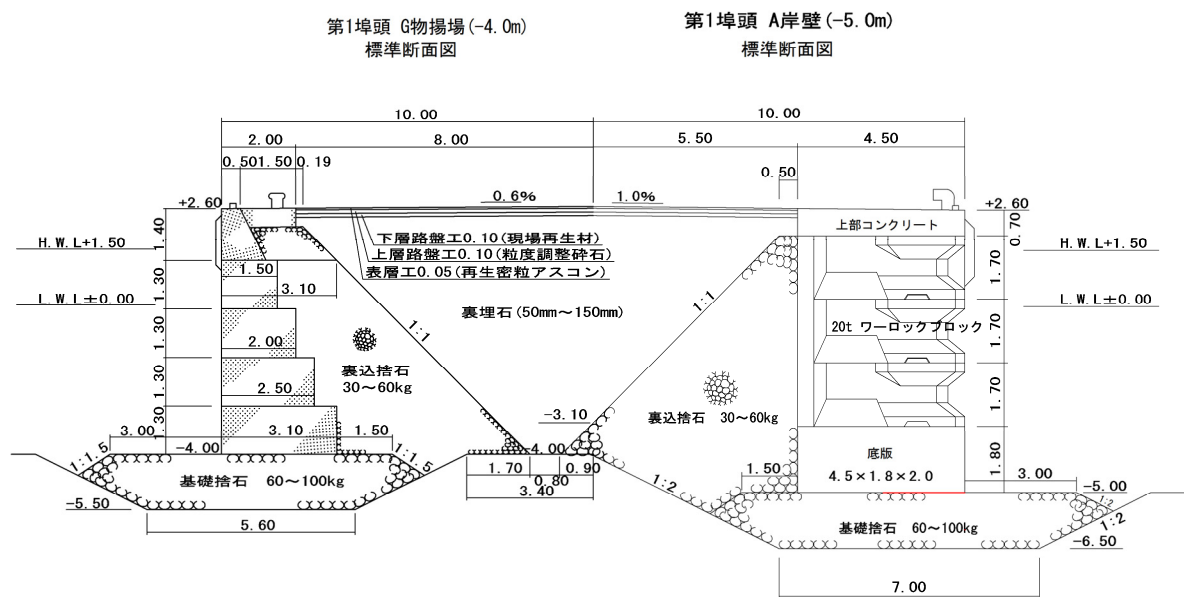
No.28 大洗港区\_第1埠頭地区 A岸壁の断面図 (被災前)
